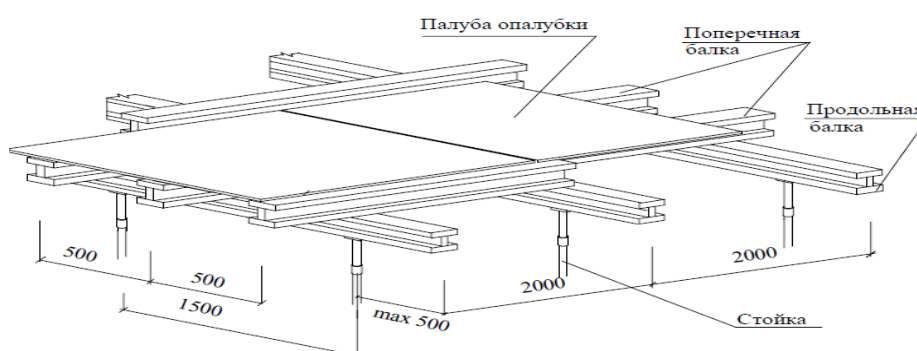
Схема устройства фанеро-дерявянной опалубки перекрытия
